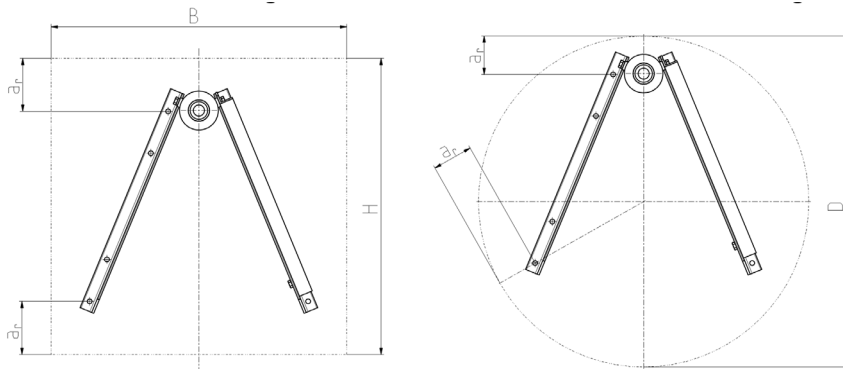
Fundamente mit quadratischem und kreisförmigem Grundriss
